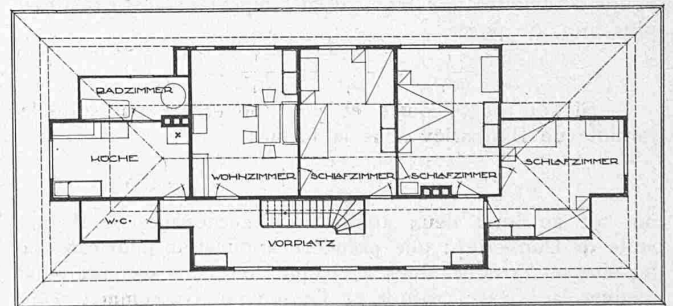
und 38. Grundrisse des Kosthauses. — Masstab 1:250.
